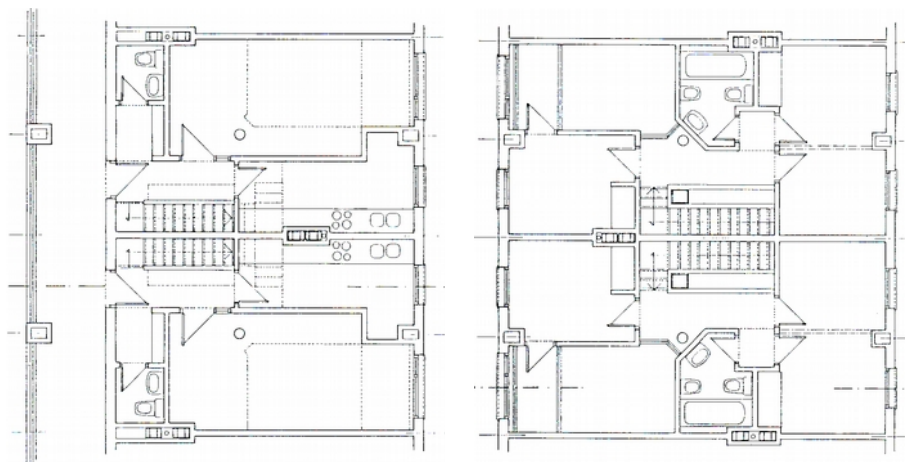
Viviendas Duplex Tipo del inmueble de Orcasitas. Planta baja con el corredor abierto al patio y planta primera. Fuente: Calle (1993)
